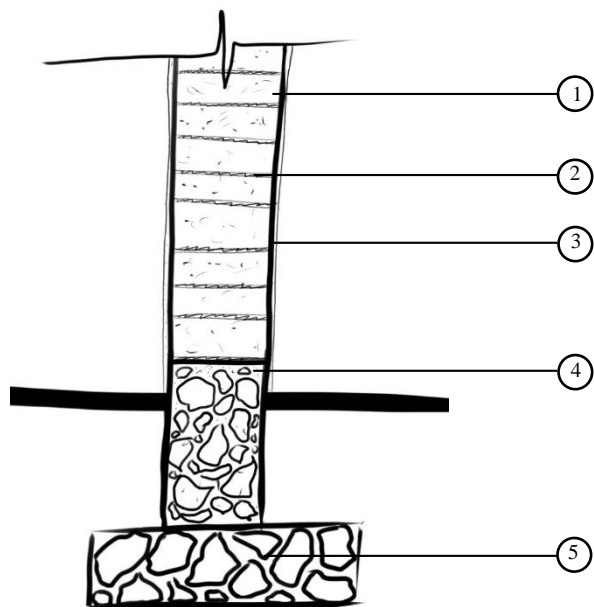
Dibujo de un muro de adobe rústico. Fuente: Propia.
